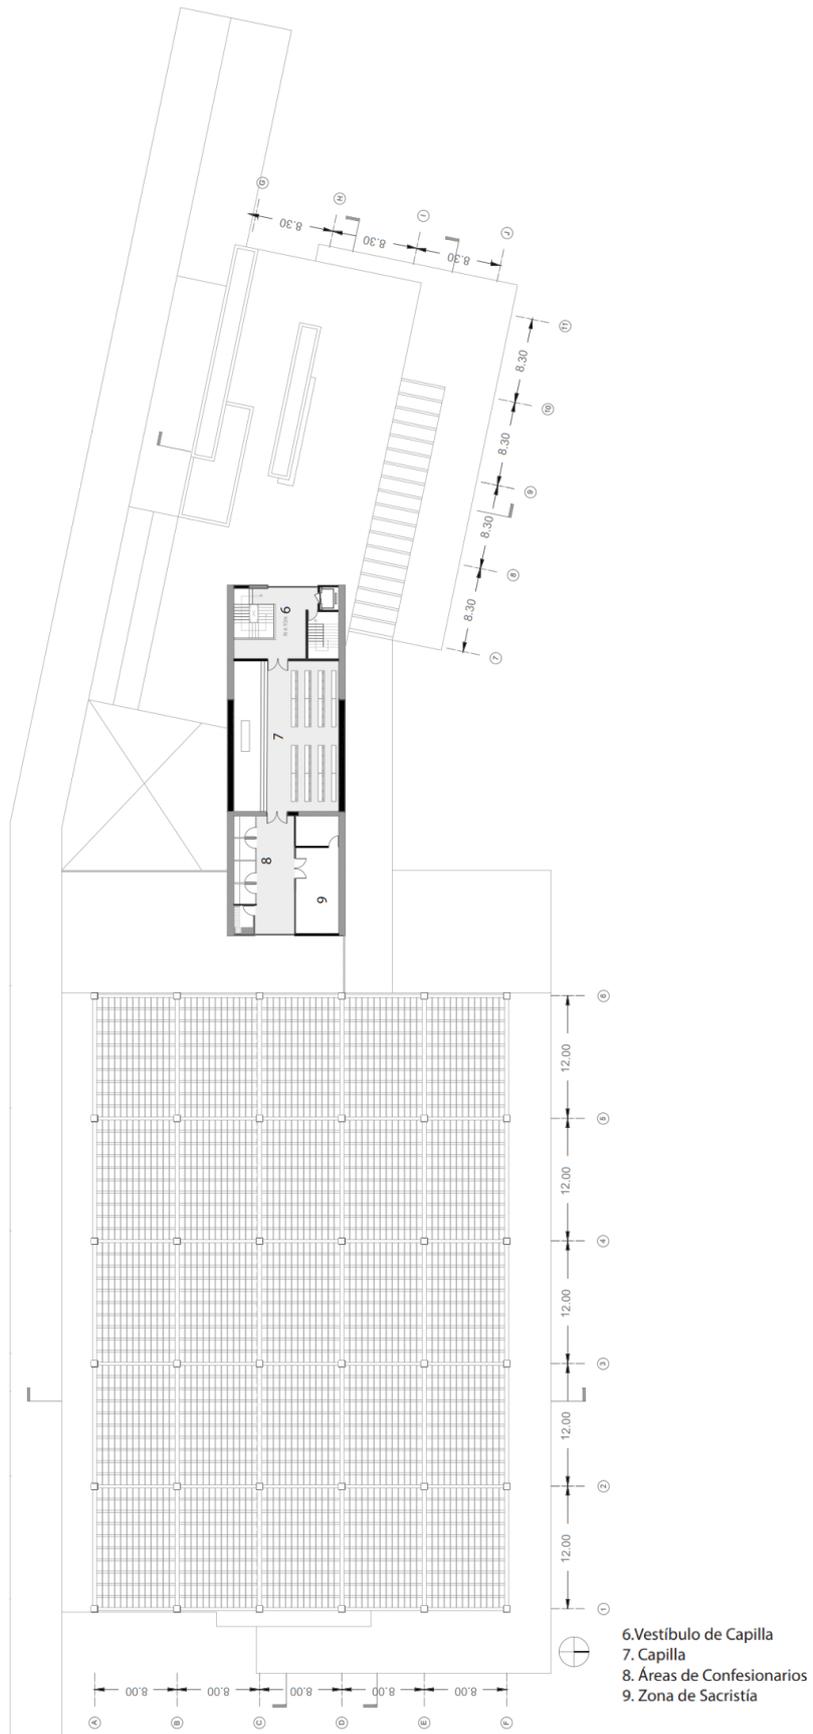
Elaboración Propia. Indicador: Planta Alta Primera N. +4.10m.
